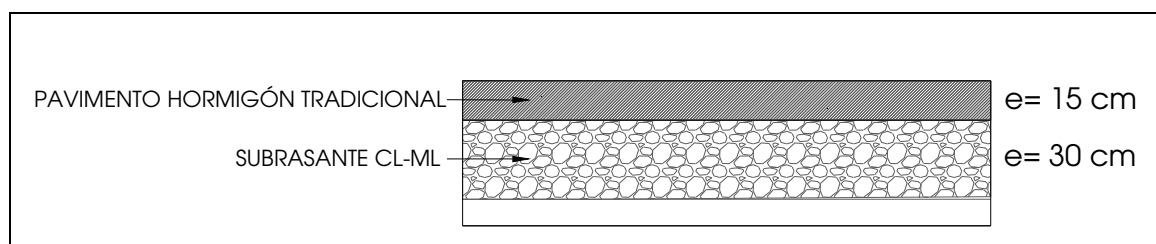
Paquete estructural del pavimento de hormigón convencional para el estacionamiento
